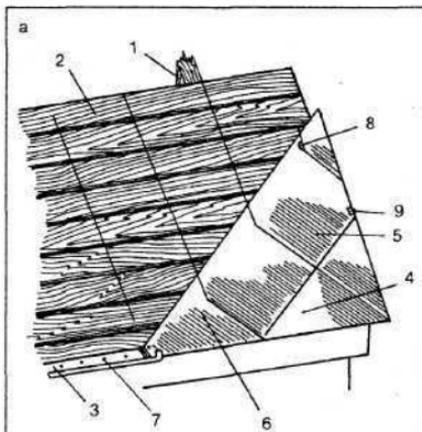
Покрытие кровли асбестоцементной плиткой:
